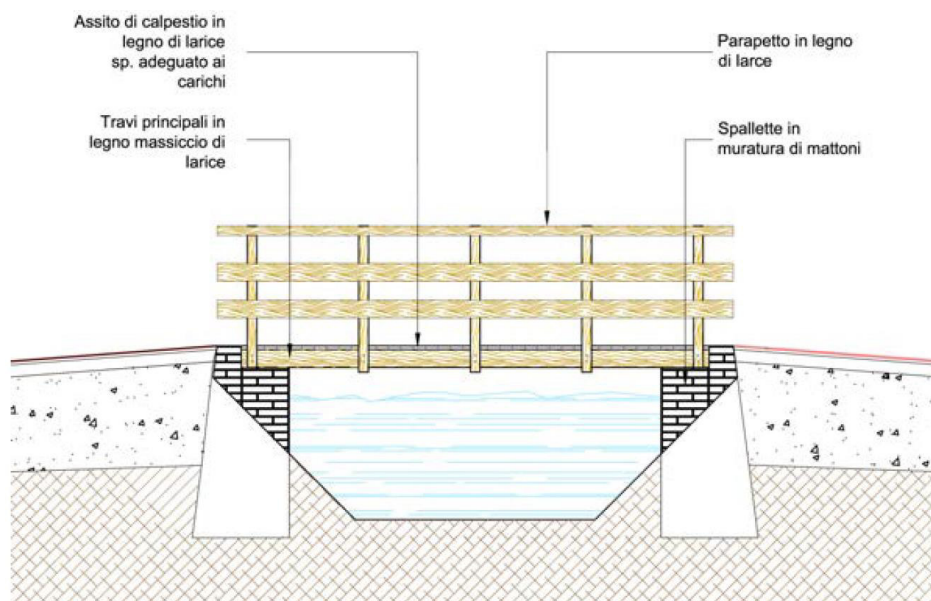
| Ponte di attraversamento della pista ciclabile sulla roggia
